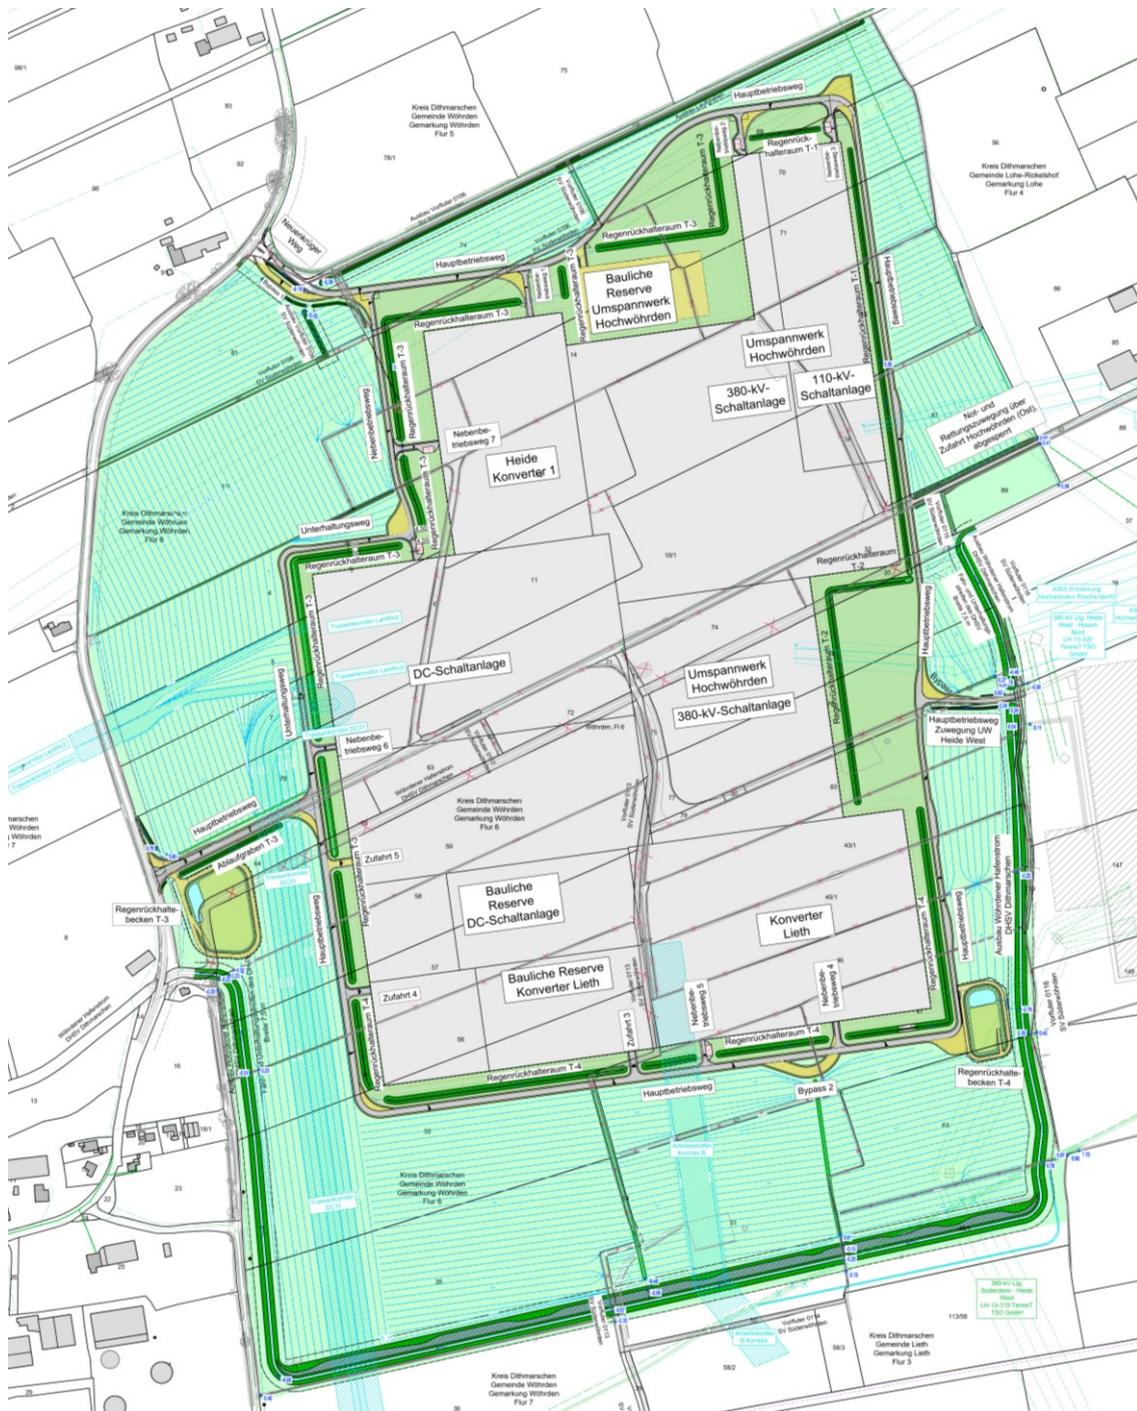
Plangebiet HeideHub mit Anlagenbereichen, Grundstücksentwässerung und innerer und äußerer Erschließung (siehe Anlage 2.4.2 Straßenbau und Entwässerung Endzustand)
